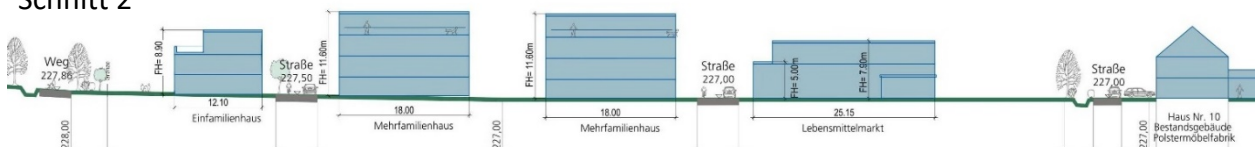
Städtebauliches Konzept Bubelesäcker, Variante 1.3.3 mit Lebensmittelmarkt – Flachdach; Quelle: Stadt Remseck am Neckar
